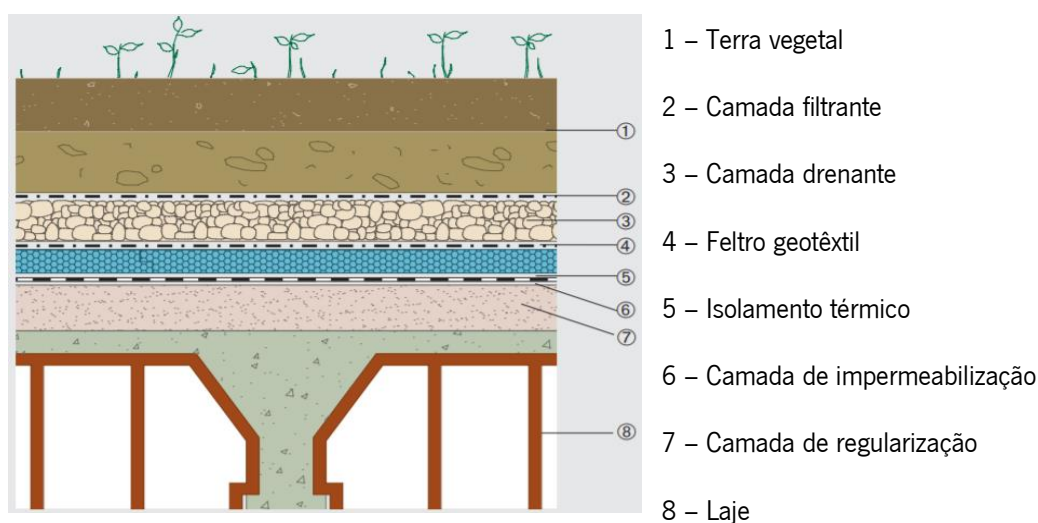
Pormenor construtivo tipo de uma cobertura ajardinada (adaptado de (DOW , n.d.))
